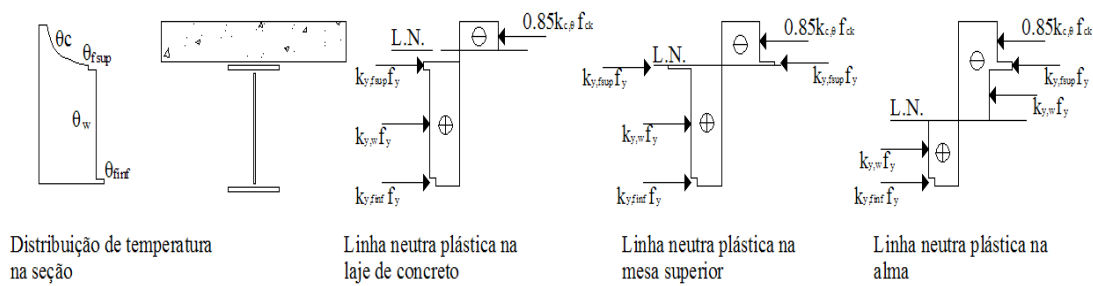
Distribuição de tensões em viga mista em situação de incêndio.
